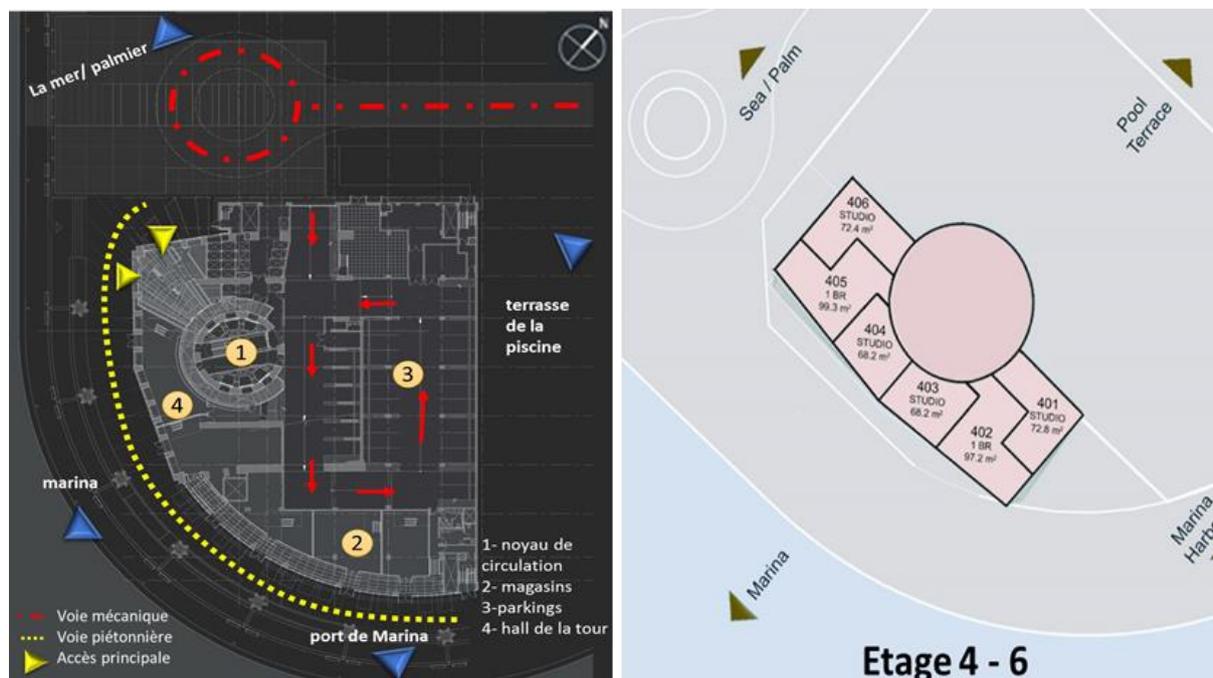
Plan de RDC (gauche) ; Plan d'étage 4 – 6 (droite).
